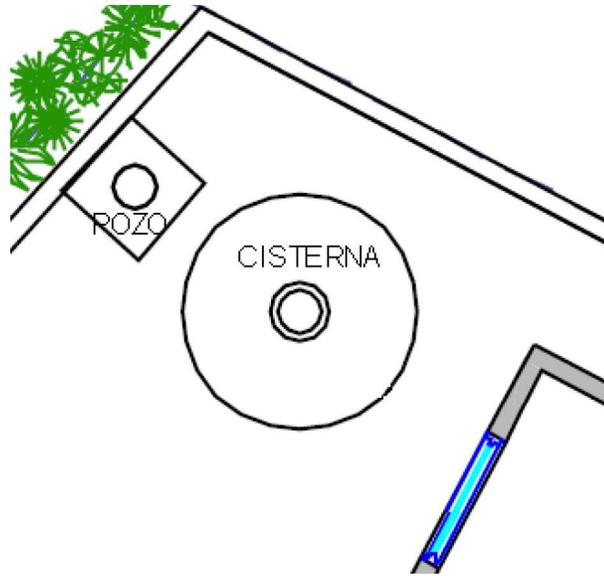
Imagen de vista en planta del pozo de la cisterna y pozo.
